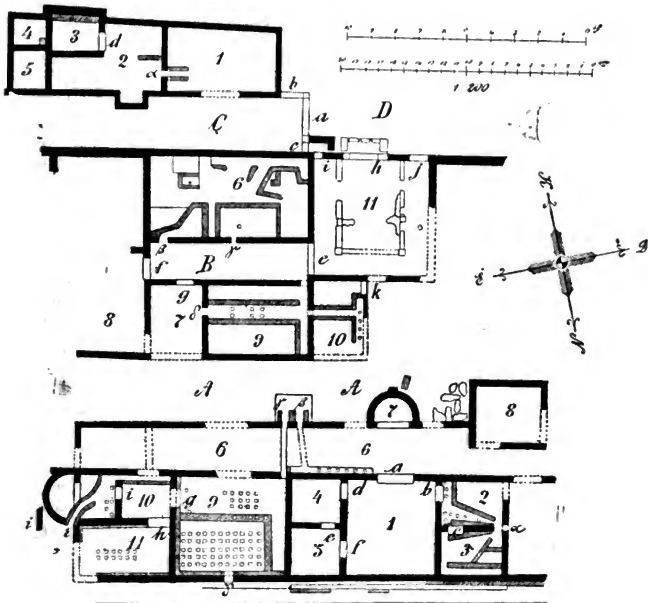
GRUNDRISS ZWEIER WOHNHÄUSER.
